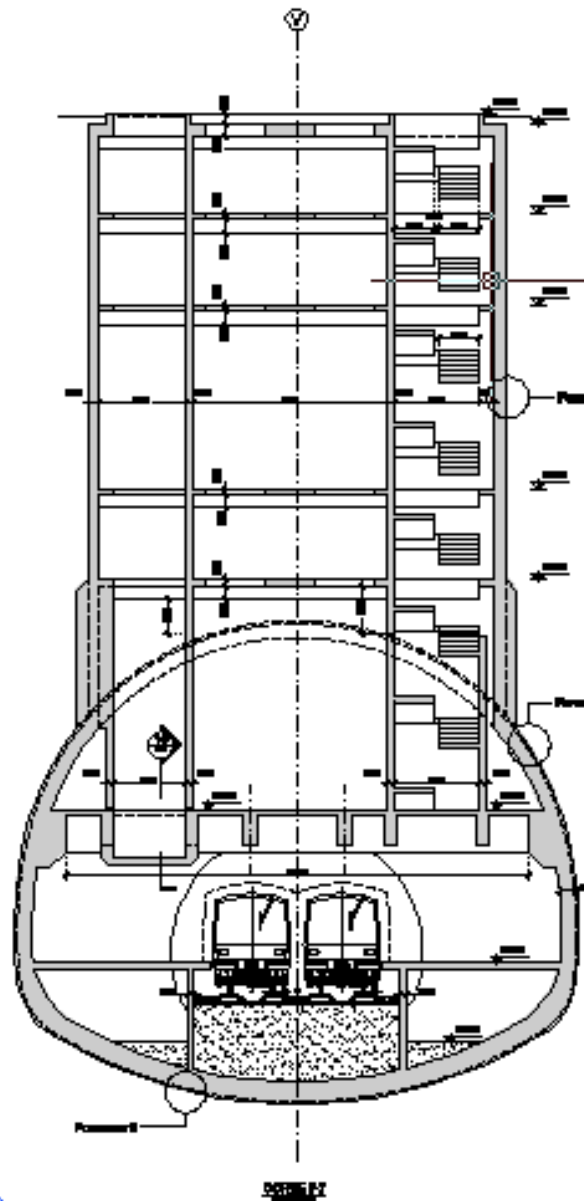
Corte Transversal ao Túnel do Cais na Zona do Poço Principal
